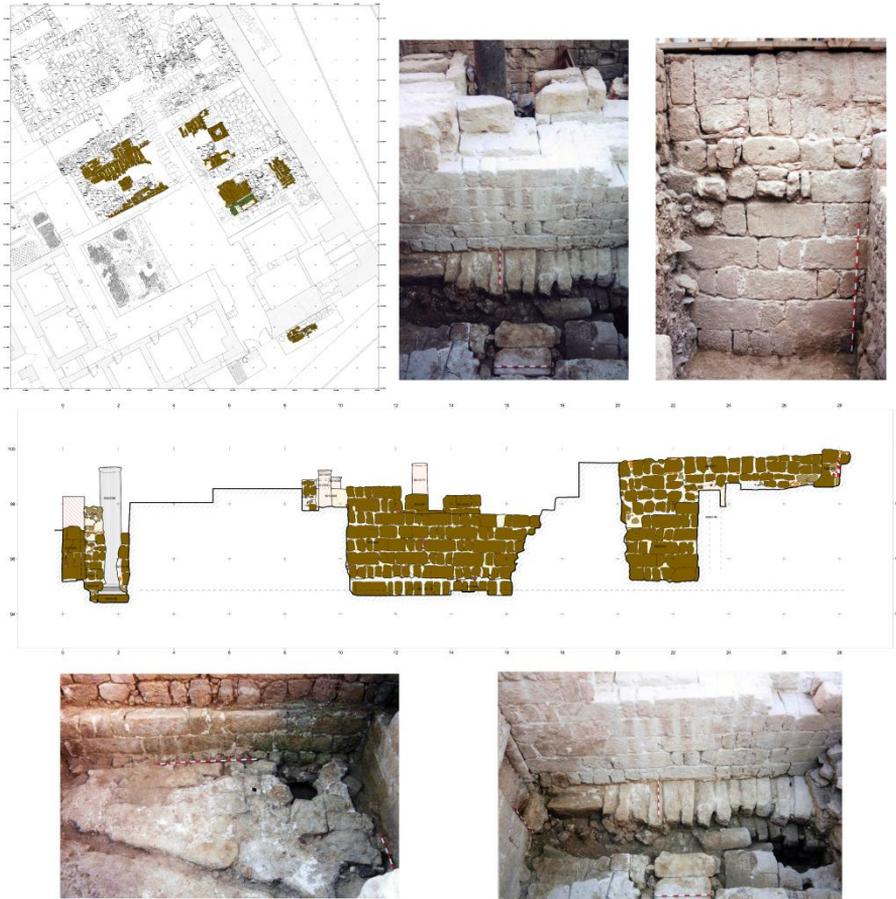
Fase Omeya califal. Planta y alzados de las estructuras con aparejo de sillería califal
